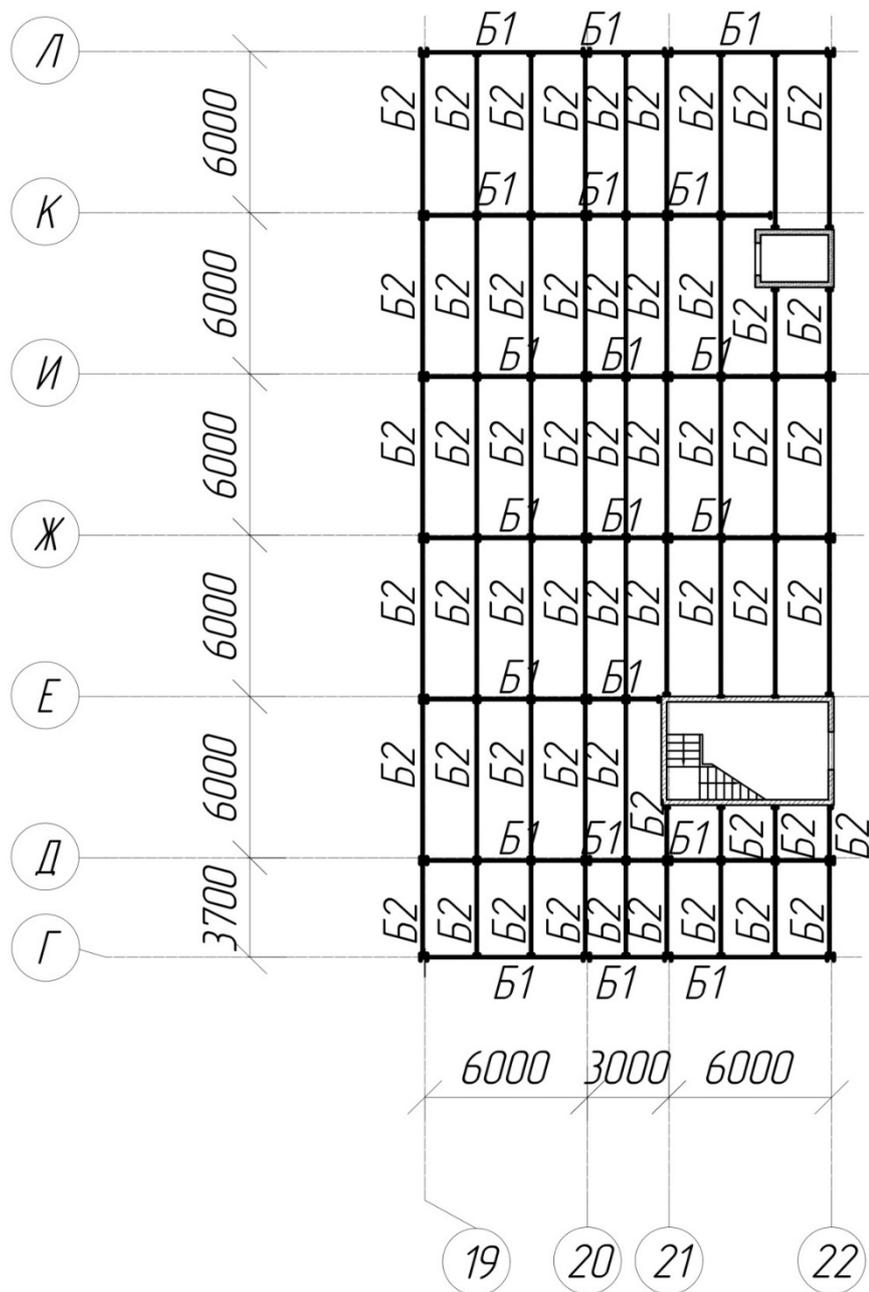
Схема расположения балок перекрытия в осях 19-22/Г-Л на отм. +3,300
